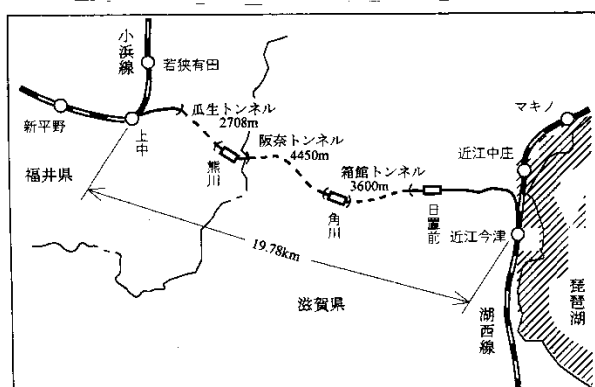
琵琶湖若狭湾快速鉄道平面図 期成同盟会ホームページを基に作図
